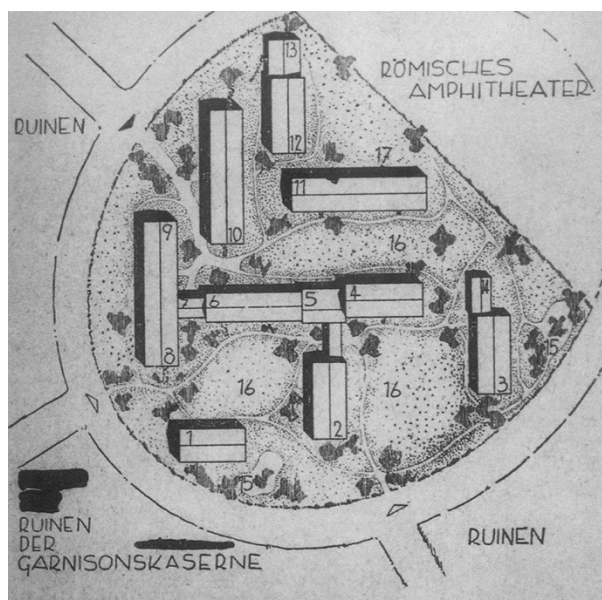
Il progetto di sistemazione delle baracche realizzato dall'architetto Felix Schwarz, 1945-'46 (Archivio Fondazione Margherita Zoebeli).
